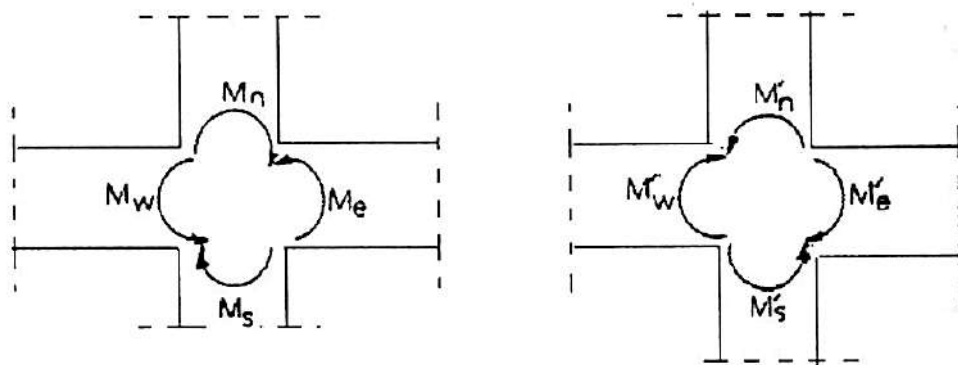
Dimensionnement d'un nœud poteau-poutre [16]
